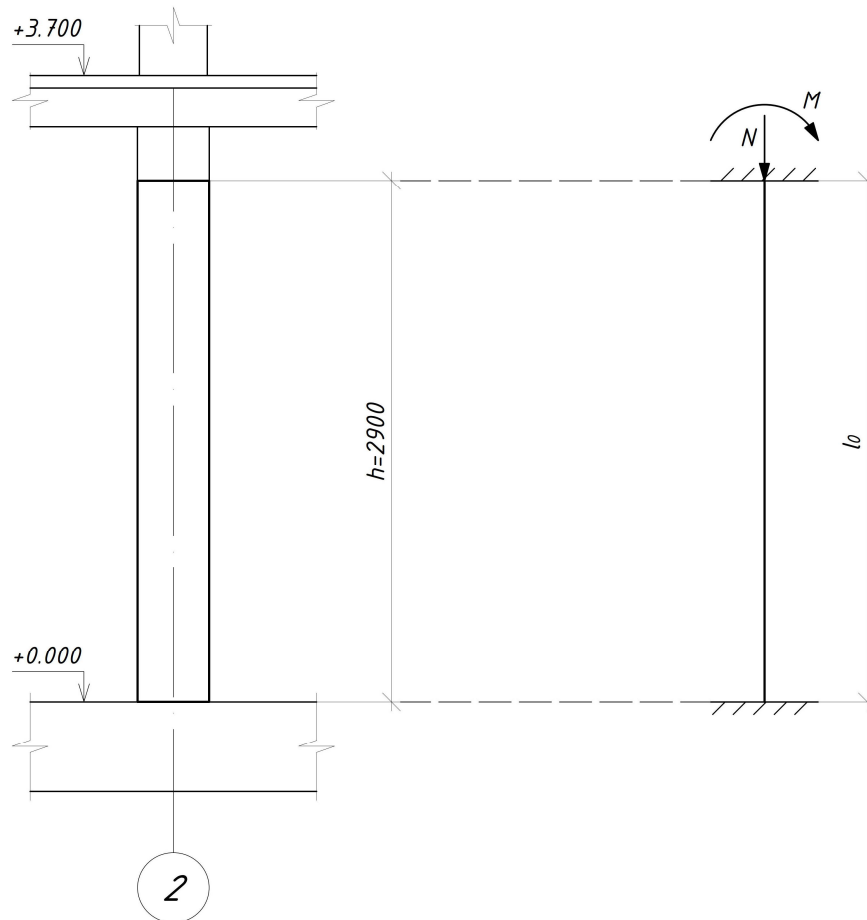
Конструктивна і розрахункова схеми колони цокольного поверху
